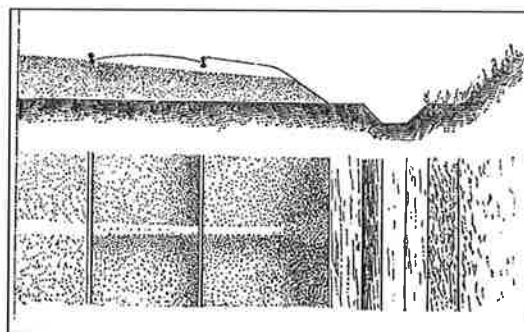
, échelle du plan : 1/100. Rigoles d'assèchement du ballast.
